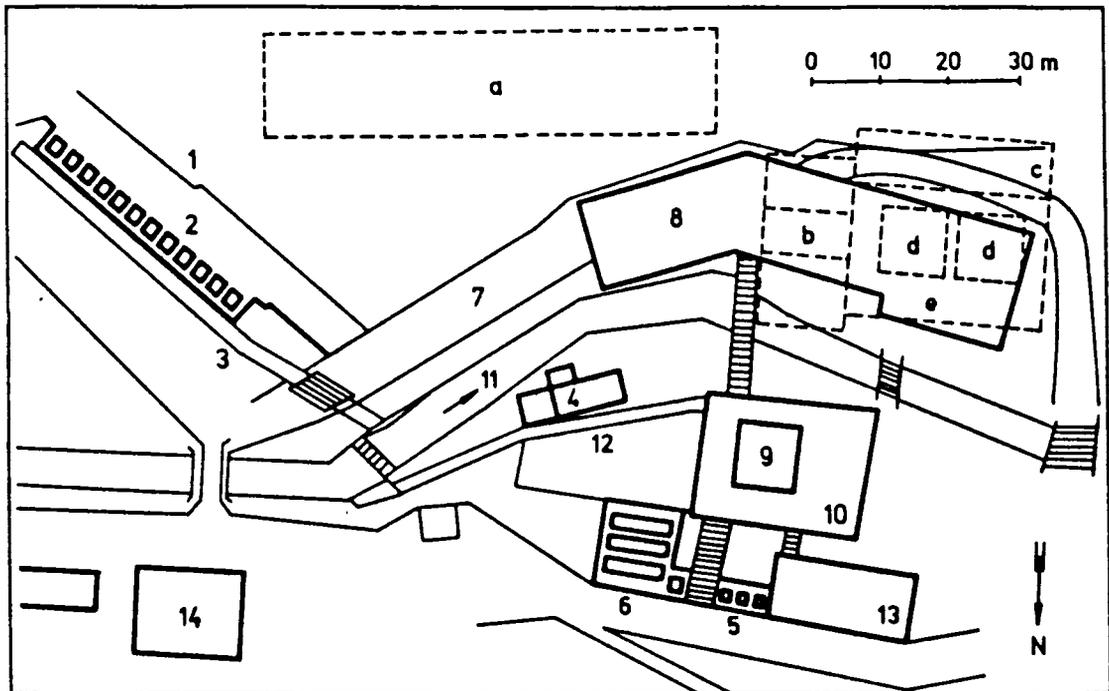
Lageplan des Hochofenwerkes in Heft. Vereinfachter Ausschnitt aus einem vom k. k. Bezirksamt Althofen am 30. April 1857 bestätigten Plan (Plan 593 im Bergbaumuseum Knappenberg); geplante Hochofenanlage strichliert eingezeichnet.
